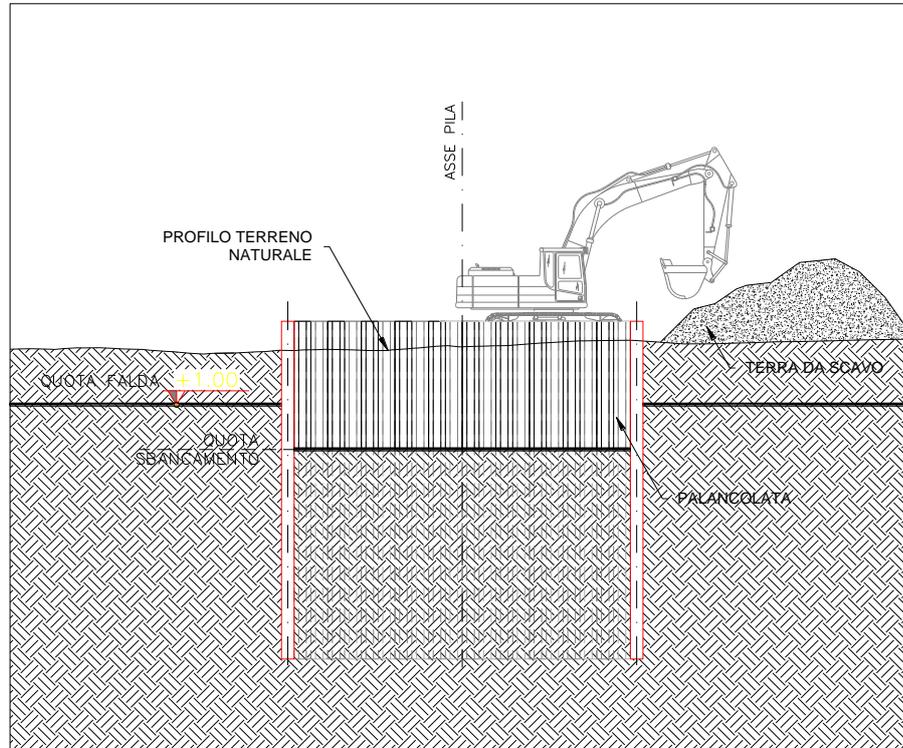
Fase realizzazione pile fondazioni viadotti
